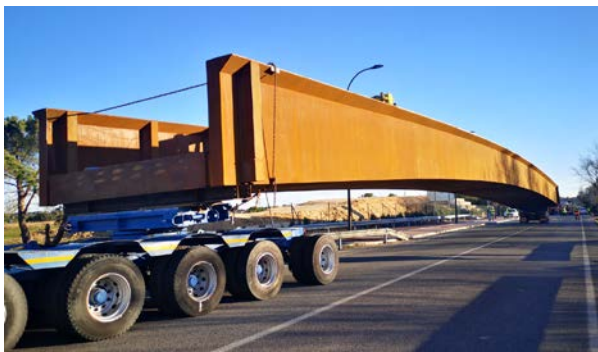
Transporte a obra de la viga en único tramo de 50,00 m.
